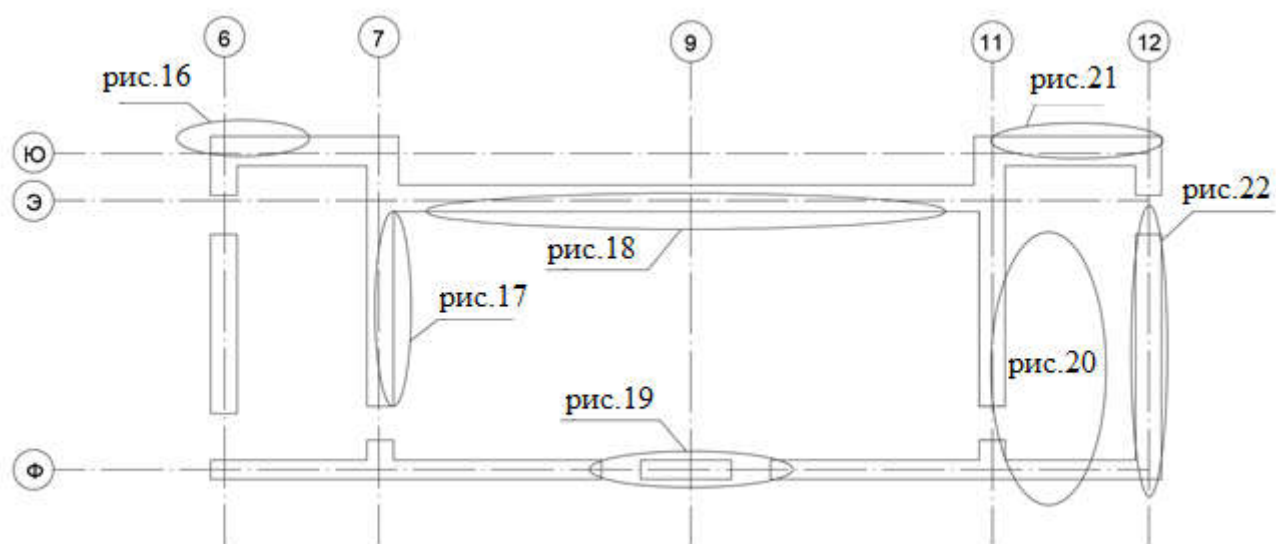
Схема нарушений фундаментов в осях Ф-Ю/6-12
